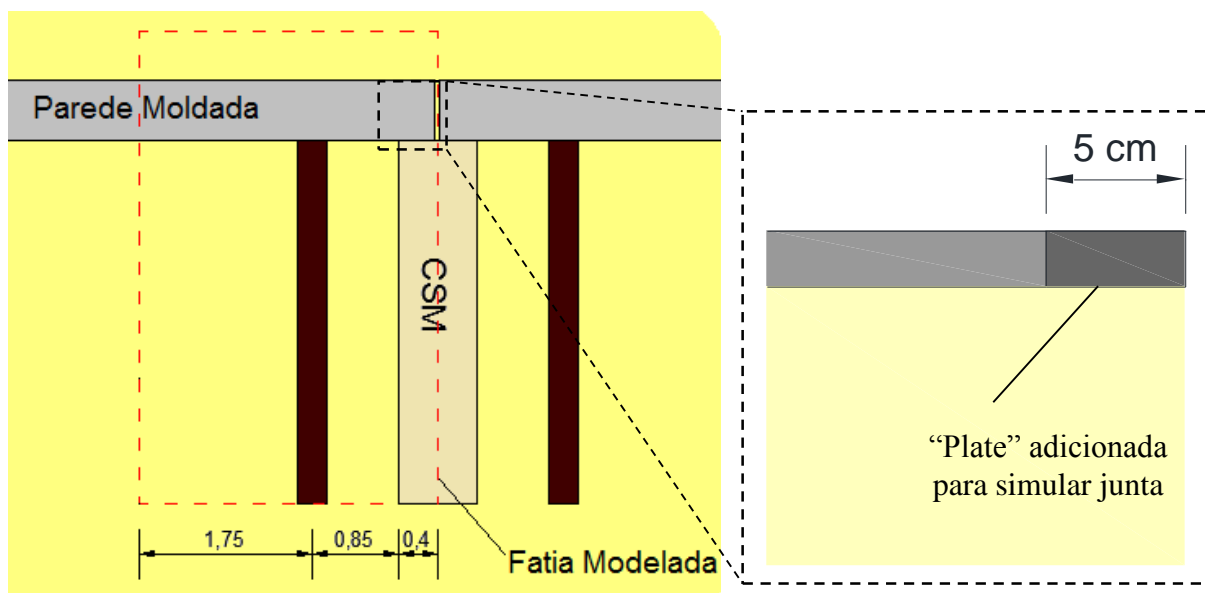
Esquema exemplificativo da aplicação de uma junta na escavação modelada.
